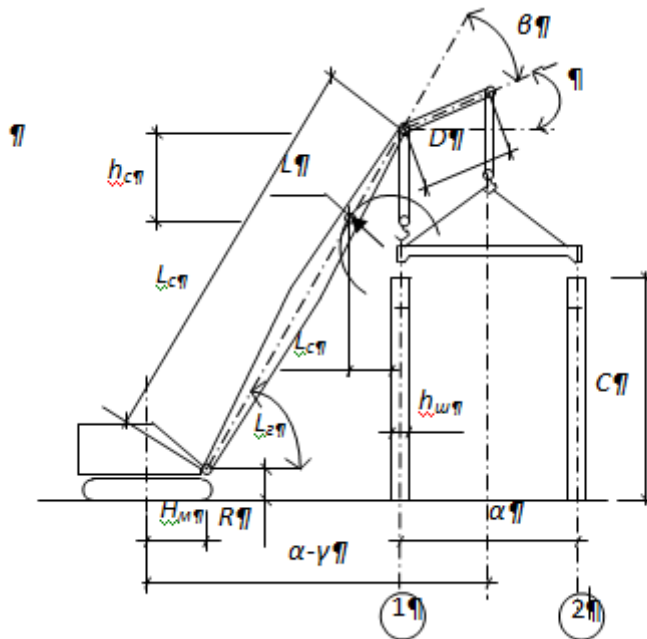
Схема визначення потрібних технічних параметрів стрілового крану обладнаного гусаким закріпленому на стрілі вище ніж висота будівлі
